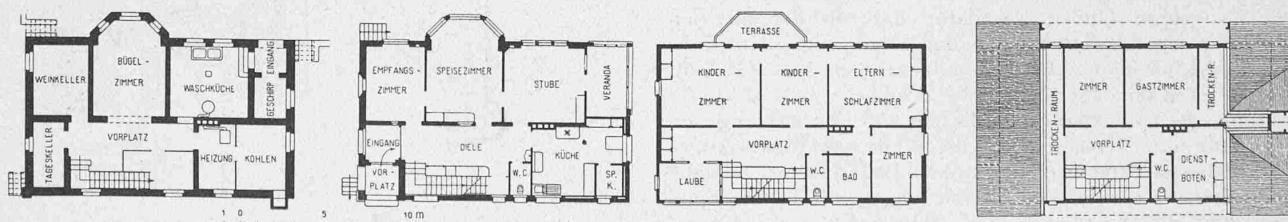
bis 4. Grundrisse vom Keller, Erdgeschoss, 1. Stock und Dachstock des Hauses Zürcher in Teufen. — Masstab 1:400.
